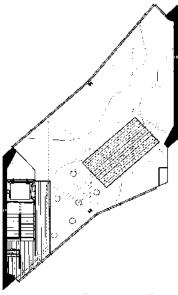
Planta TORRE 41. Alberto Kalach. www.archdaily.mx
